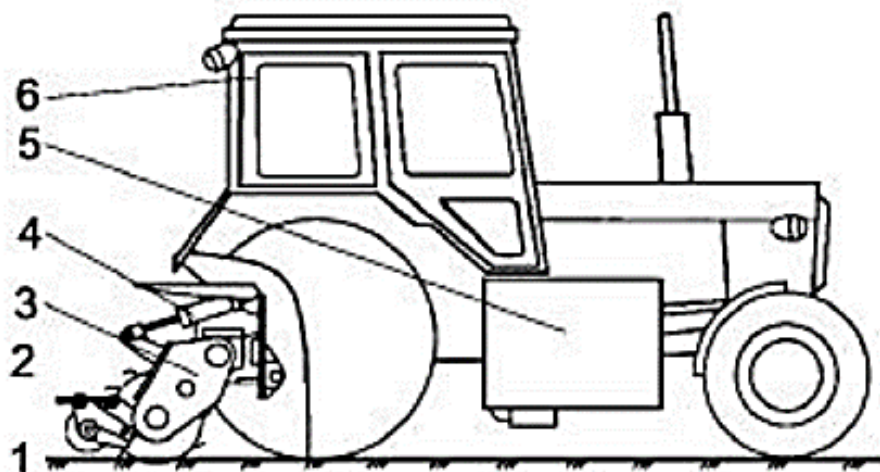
Конструктивная схема навесной дорожной фрезы:
